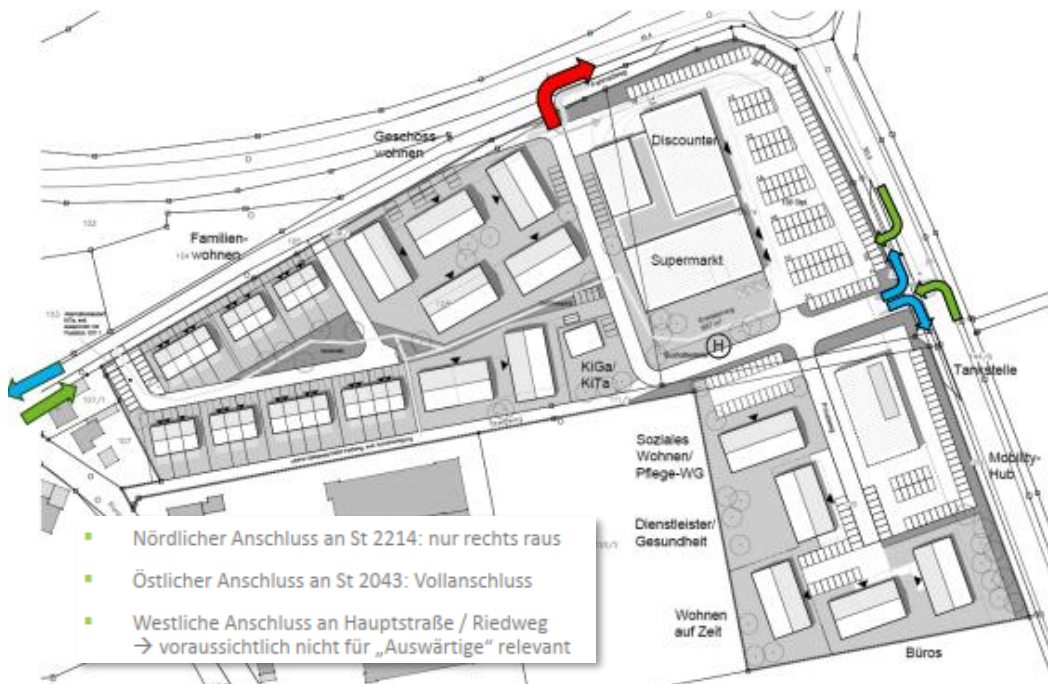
Erschließungsvariante mit 2-Richtungsverkehr auf der geplanten „Ringstraße“¹⁵
